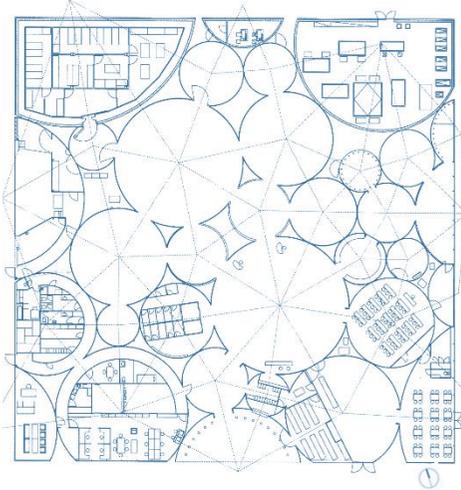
Planta arquitectónica del proyecto. Se puede apreciar como cada cilindro se conecta uno con otro creando muchas posibilidades en los recorridos.
